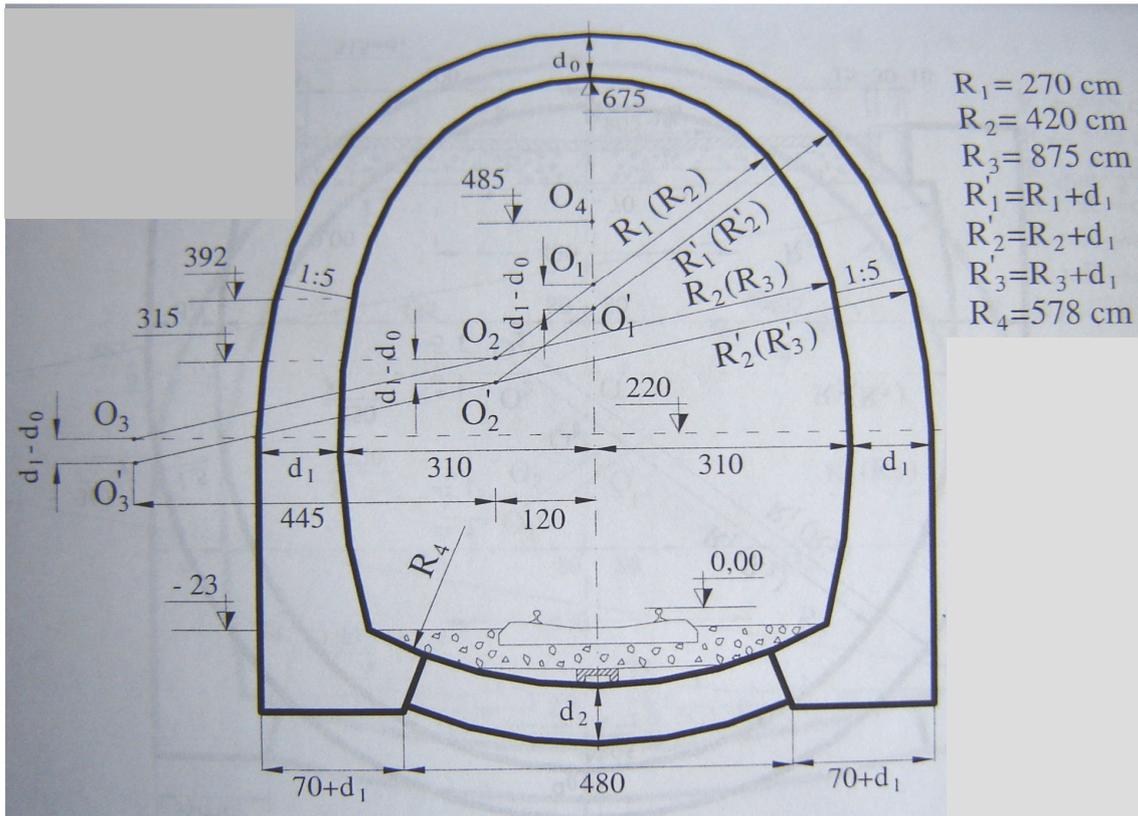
Typenprofil für einspurigen Eisenbahntunnel
